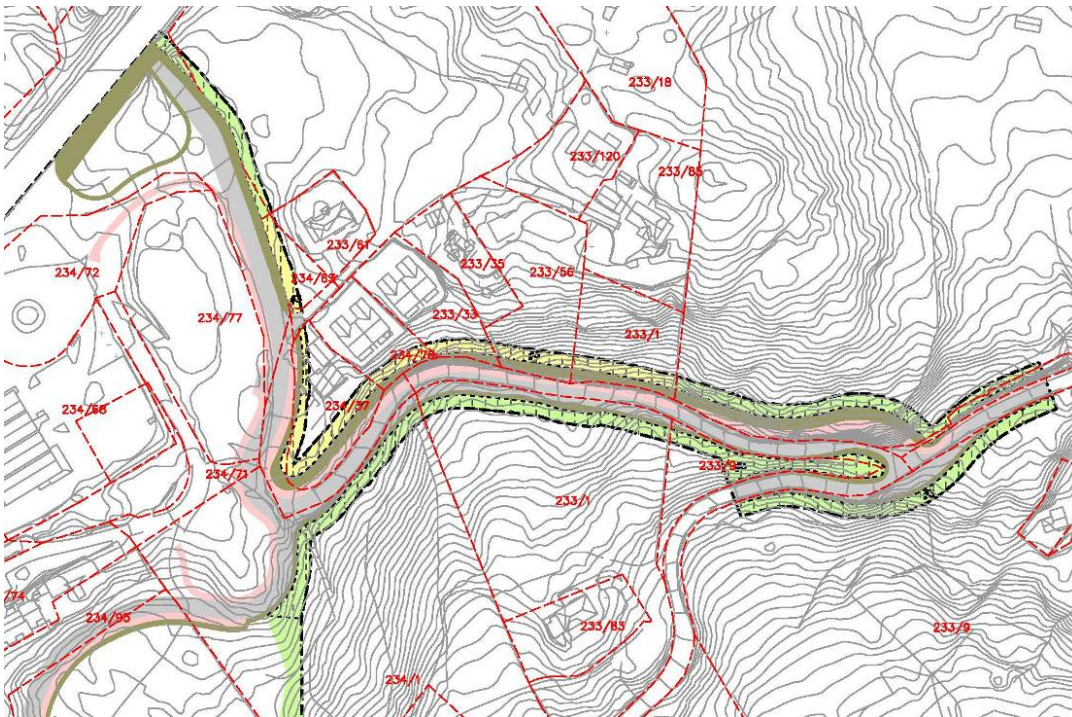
Utsnitt som viser føresegsområde #1, siktaksar(ABO Plan & Arkitektur AS)
